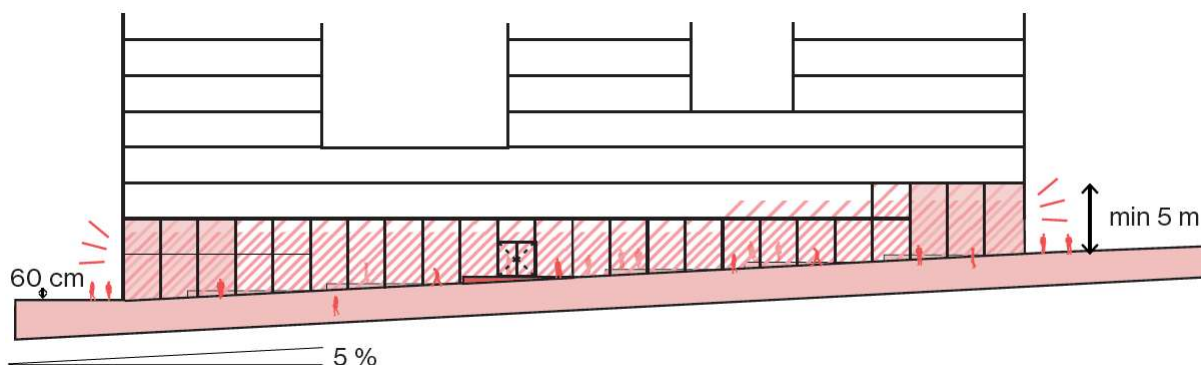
Traitement des rez-de-chaussée en pente du parvis de Beaulieu (ORG, 2018)
